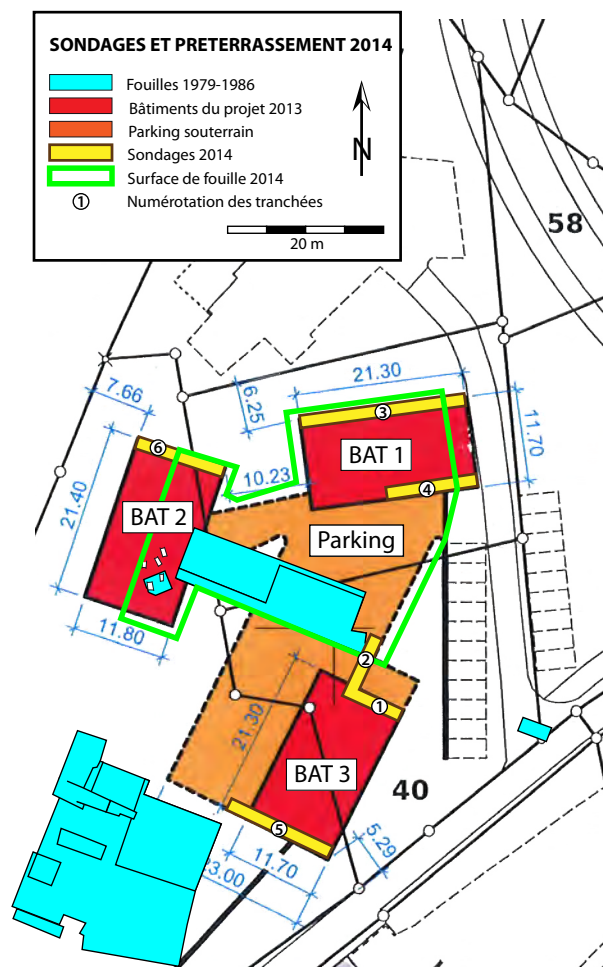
CP14. Plan de situation du projet de construction, des sondages préventifs et du terrassement.
